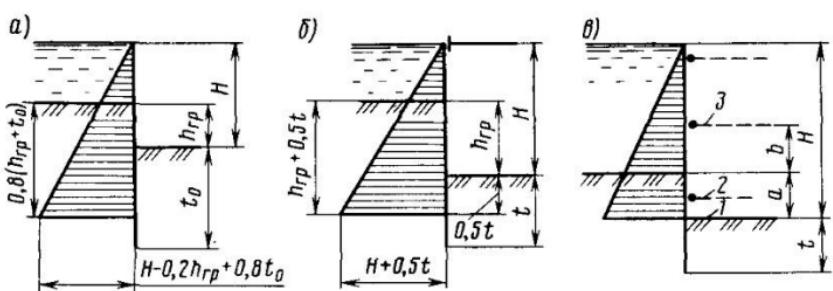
Эпюры гидростатического давления в пределах связного грунта:
